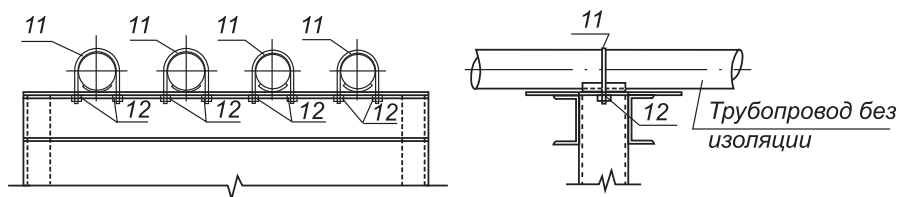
Скользящая хомутная опора на стальных трубопроводах в камере.
